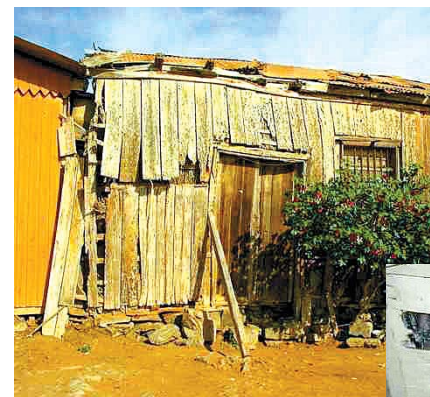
Viviendas con daño de *Cryptotermes brevis*.
